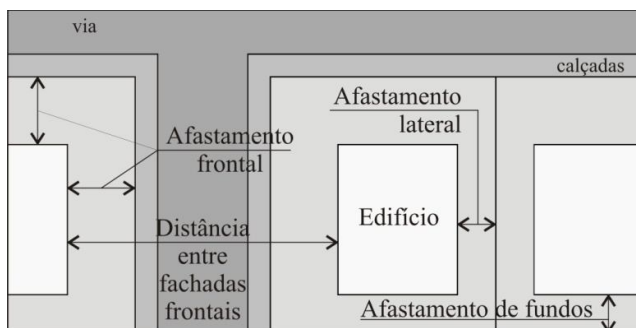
Indicação em planta baixa esquemática de distância entre fachadas frontais, afastamentos frontais, laterais e de fundos.
